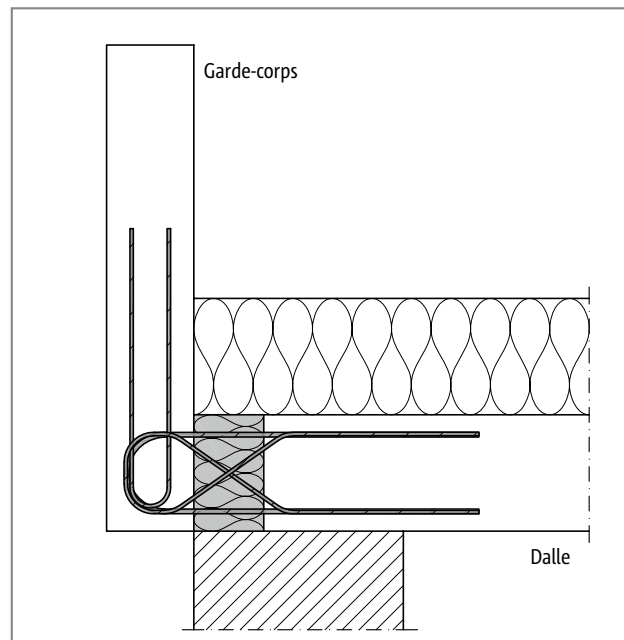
Schöck Isokorb® T Type F : Raccordement d'un garde-corps avancé avec maçonnerie isolante
